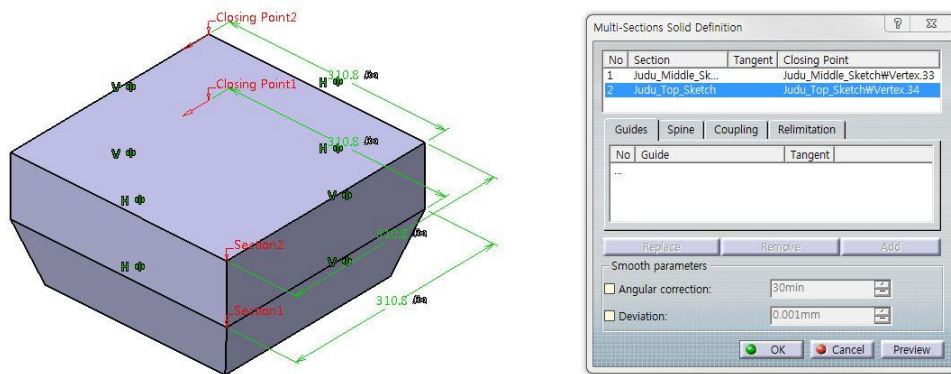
Multi-Sections Solid Definition : Judu Body B
